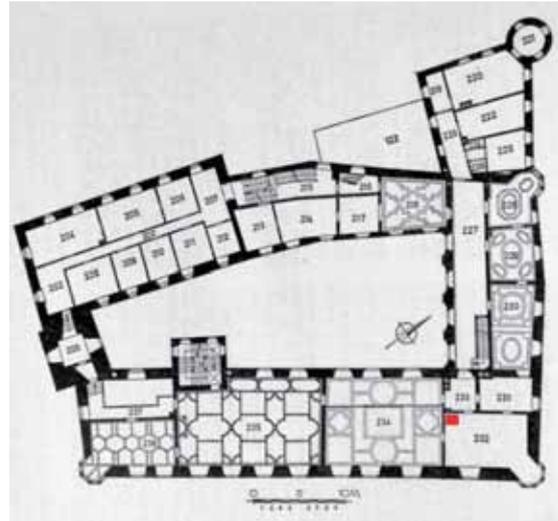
Grundriss 2. OG (HOJER, S. 287)
